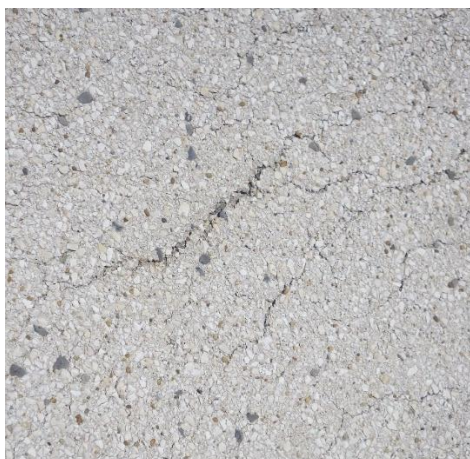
Défaut n°5 – Fissure en RG sur bande n°28
